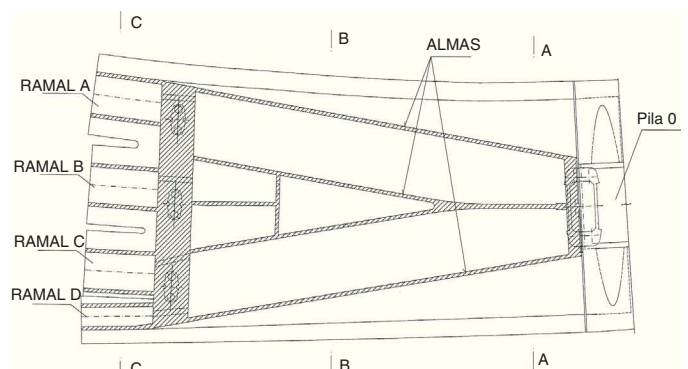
Viaducto zona de transición. Planta de las almas del tablero.
